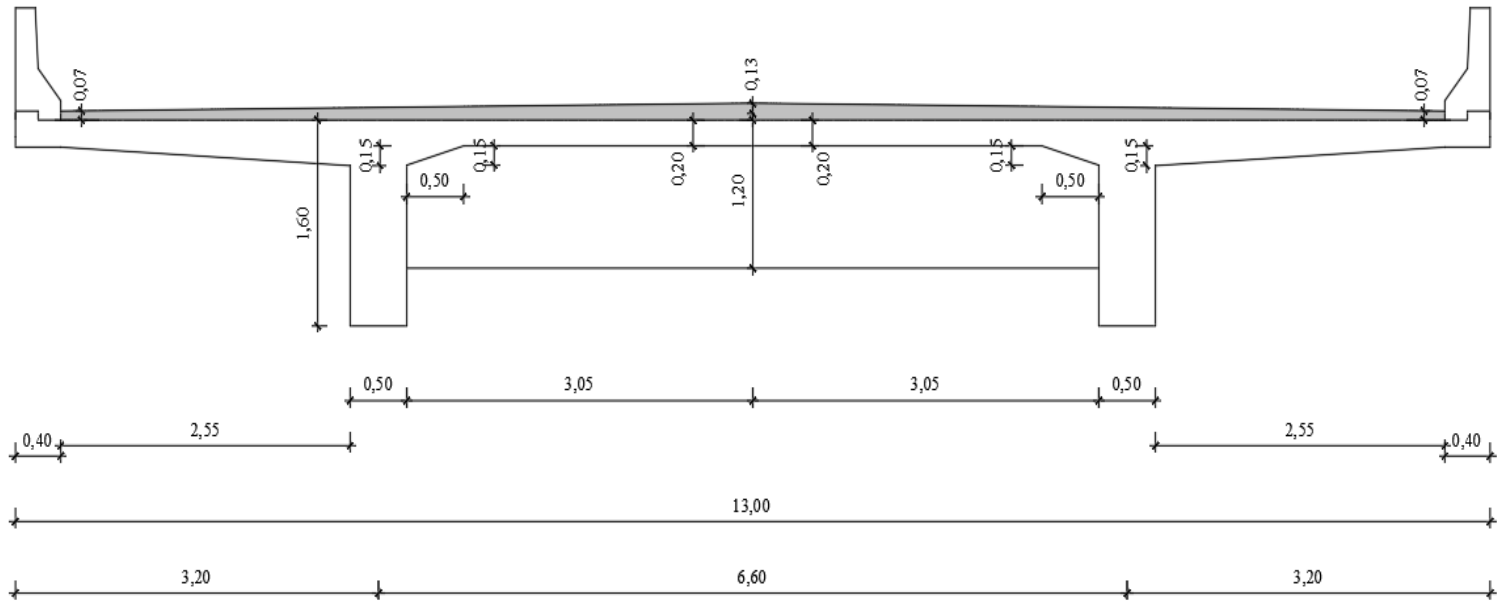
Seção transversal da ponte – Meio do vão. Fonte: Autor (2018).
